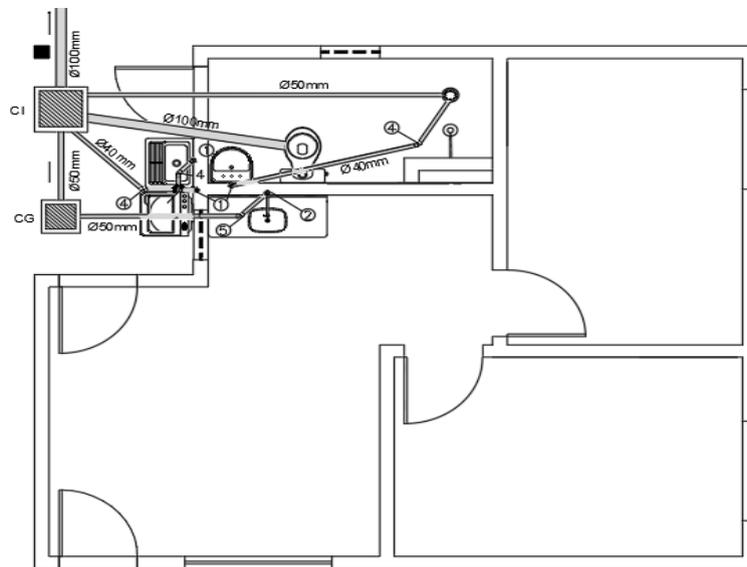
Detalhamento do projeto instalação hidráulica, projeto inicial, software AutoCad
